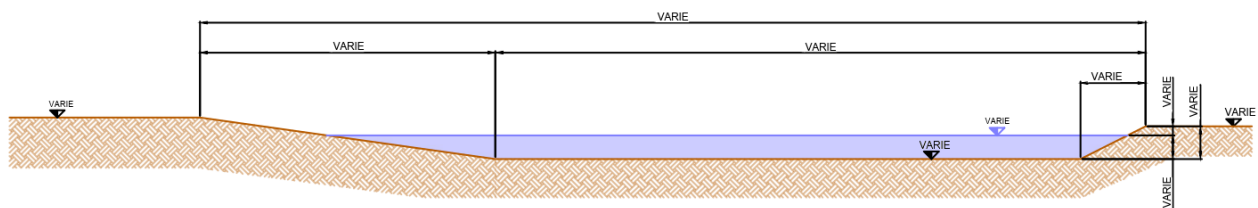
SEZIONE TIPOLOGICA BACINI DI ACCUMULO DI PROGETTO
